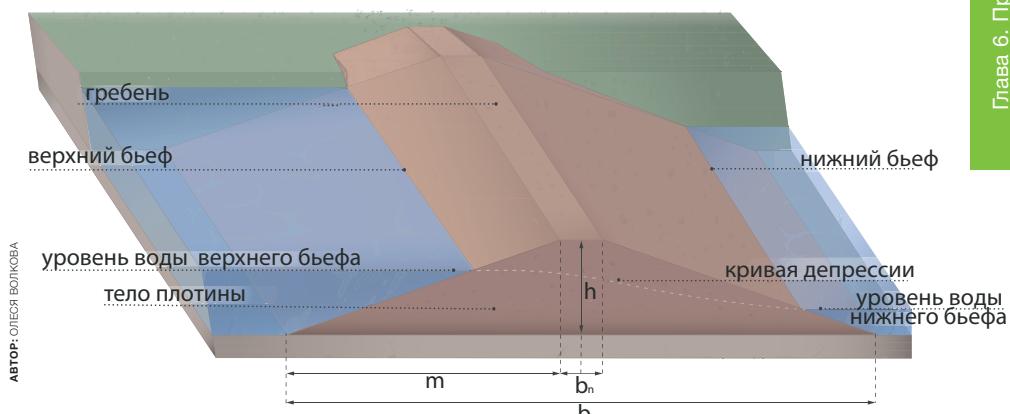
Схема грунтовой перемычки с указанием её элементов
